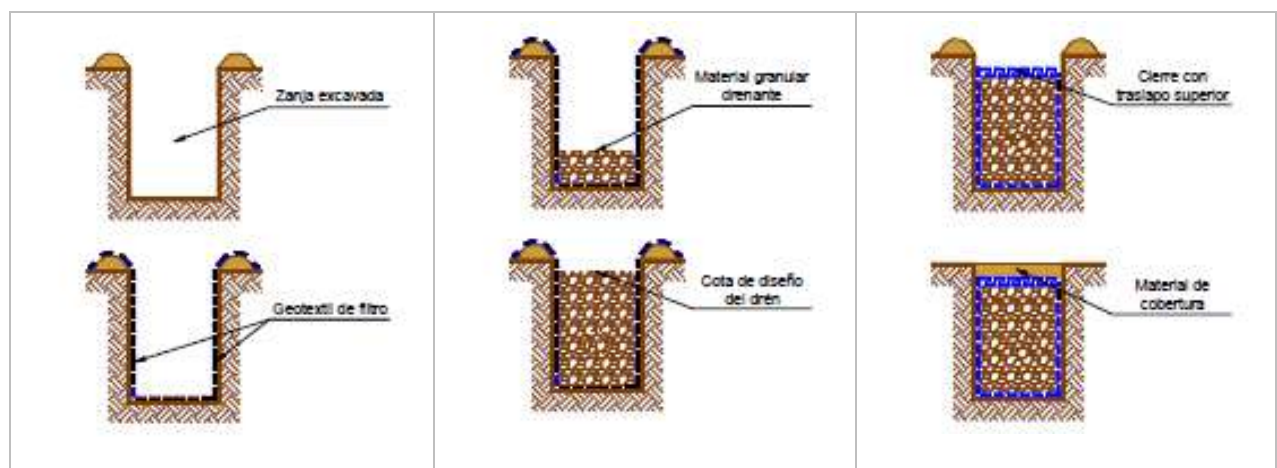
Diseño y Construcción de Subdrenes con Geotextil y Material Granular
